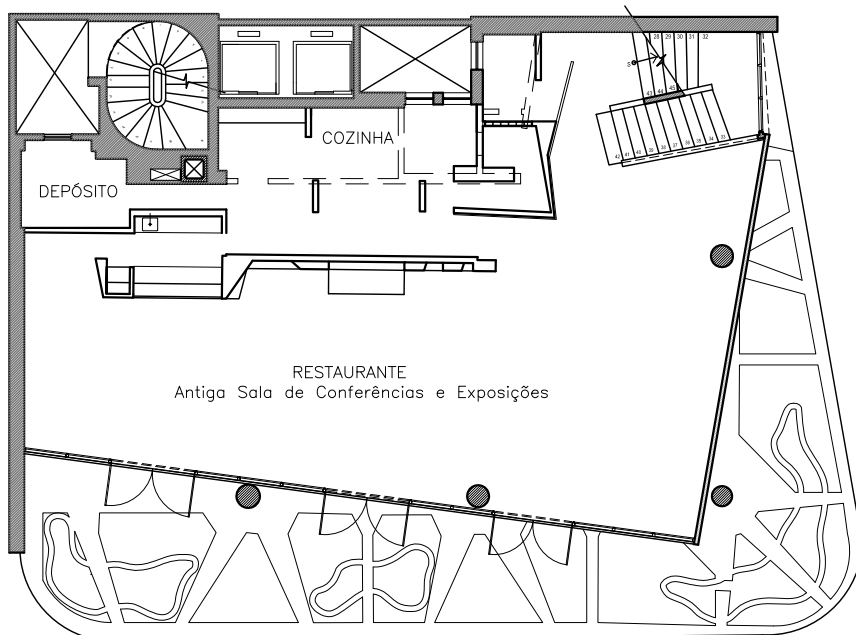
Planta da marquise inferior após a remoção do entulho - 1:200
